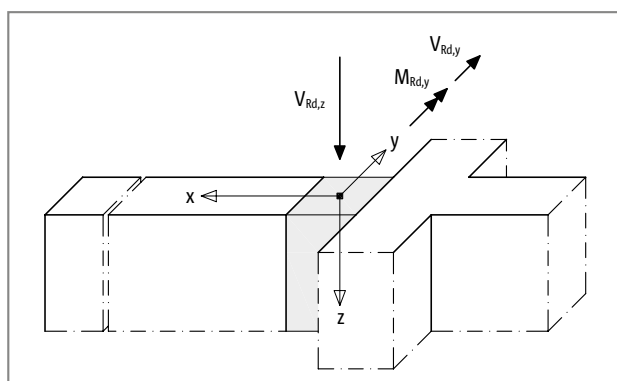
Schöck Isokorb® XT Typ WL: Vorzeichenregel für die Bemessung
